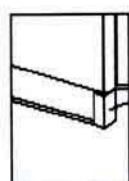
Detalle de las juntas de las placas de yeso laminado
